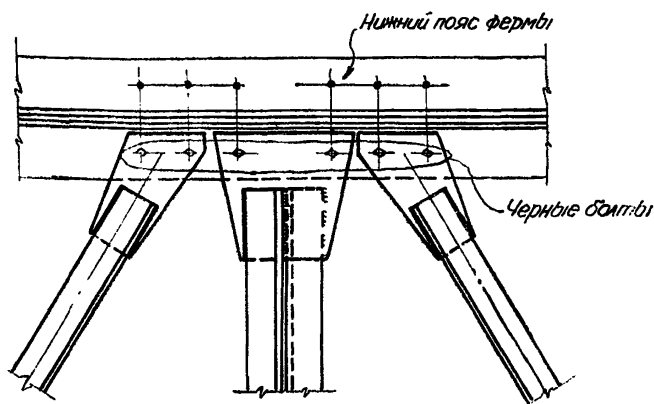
Крепление крестов связей по нижним поясам ферм на отдельных фасонках
